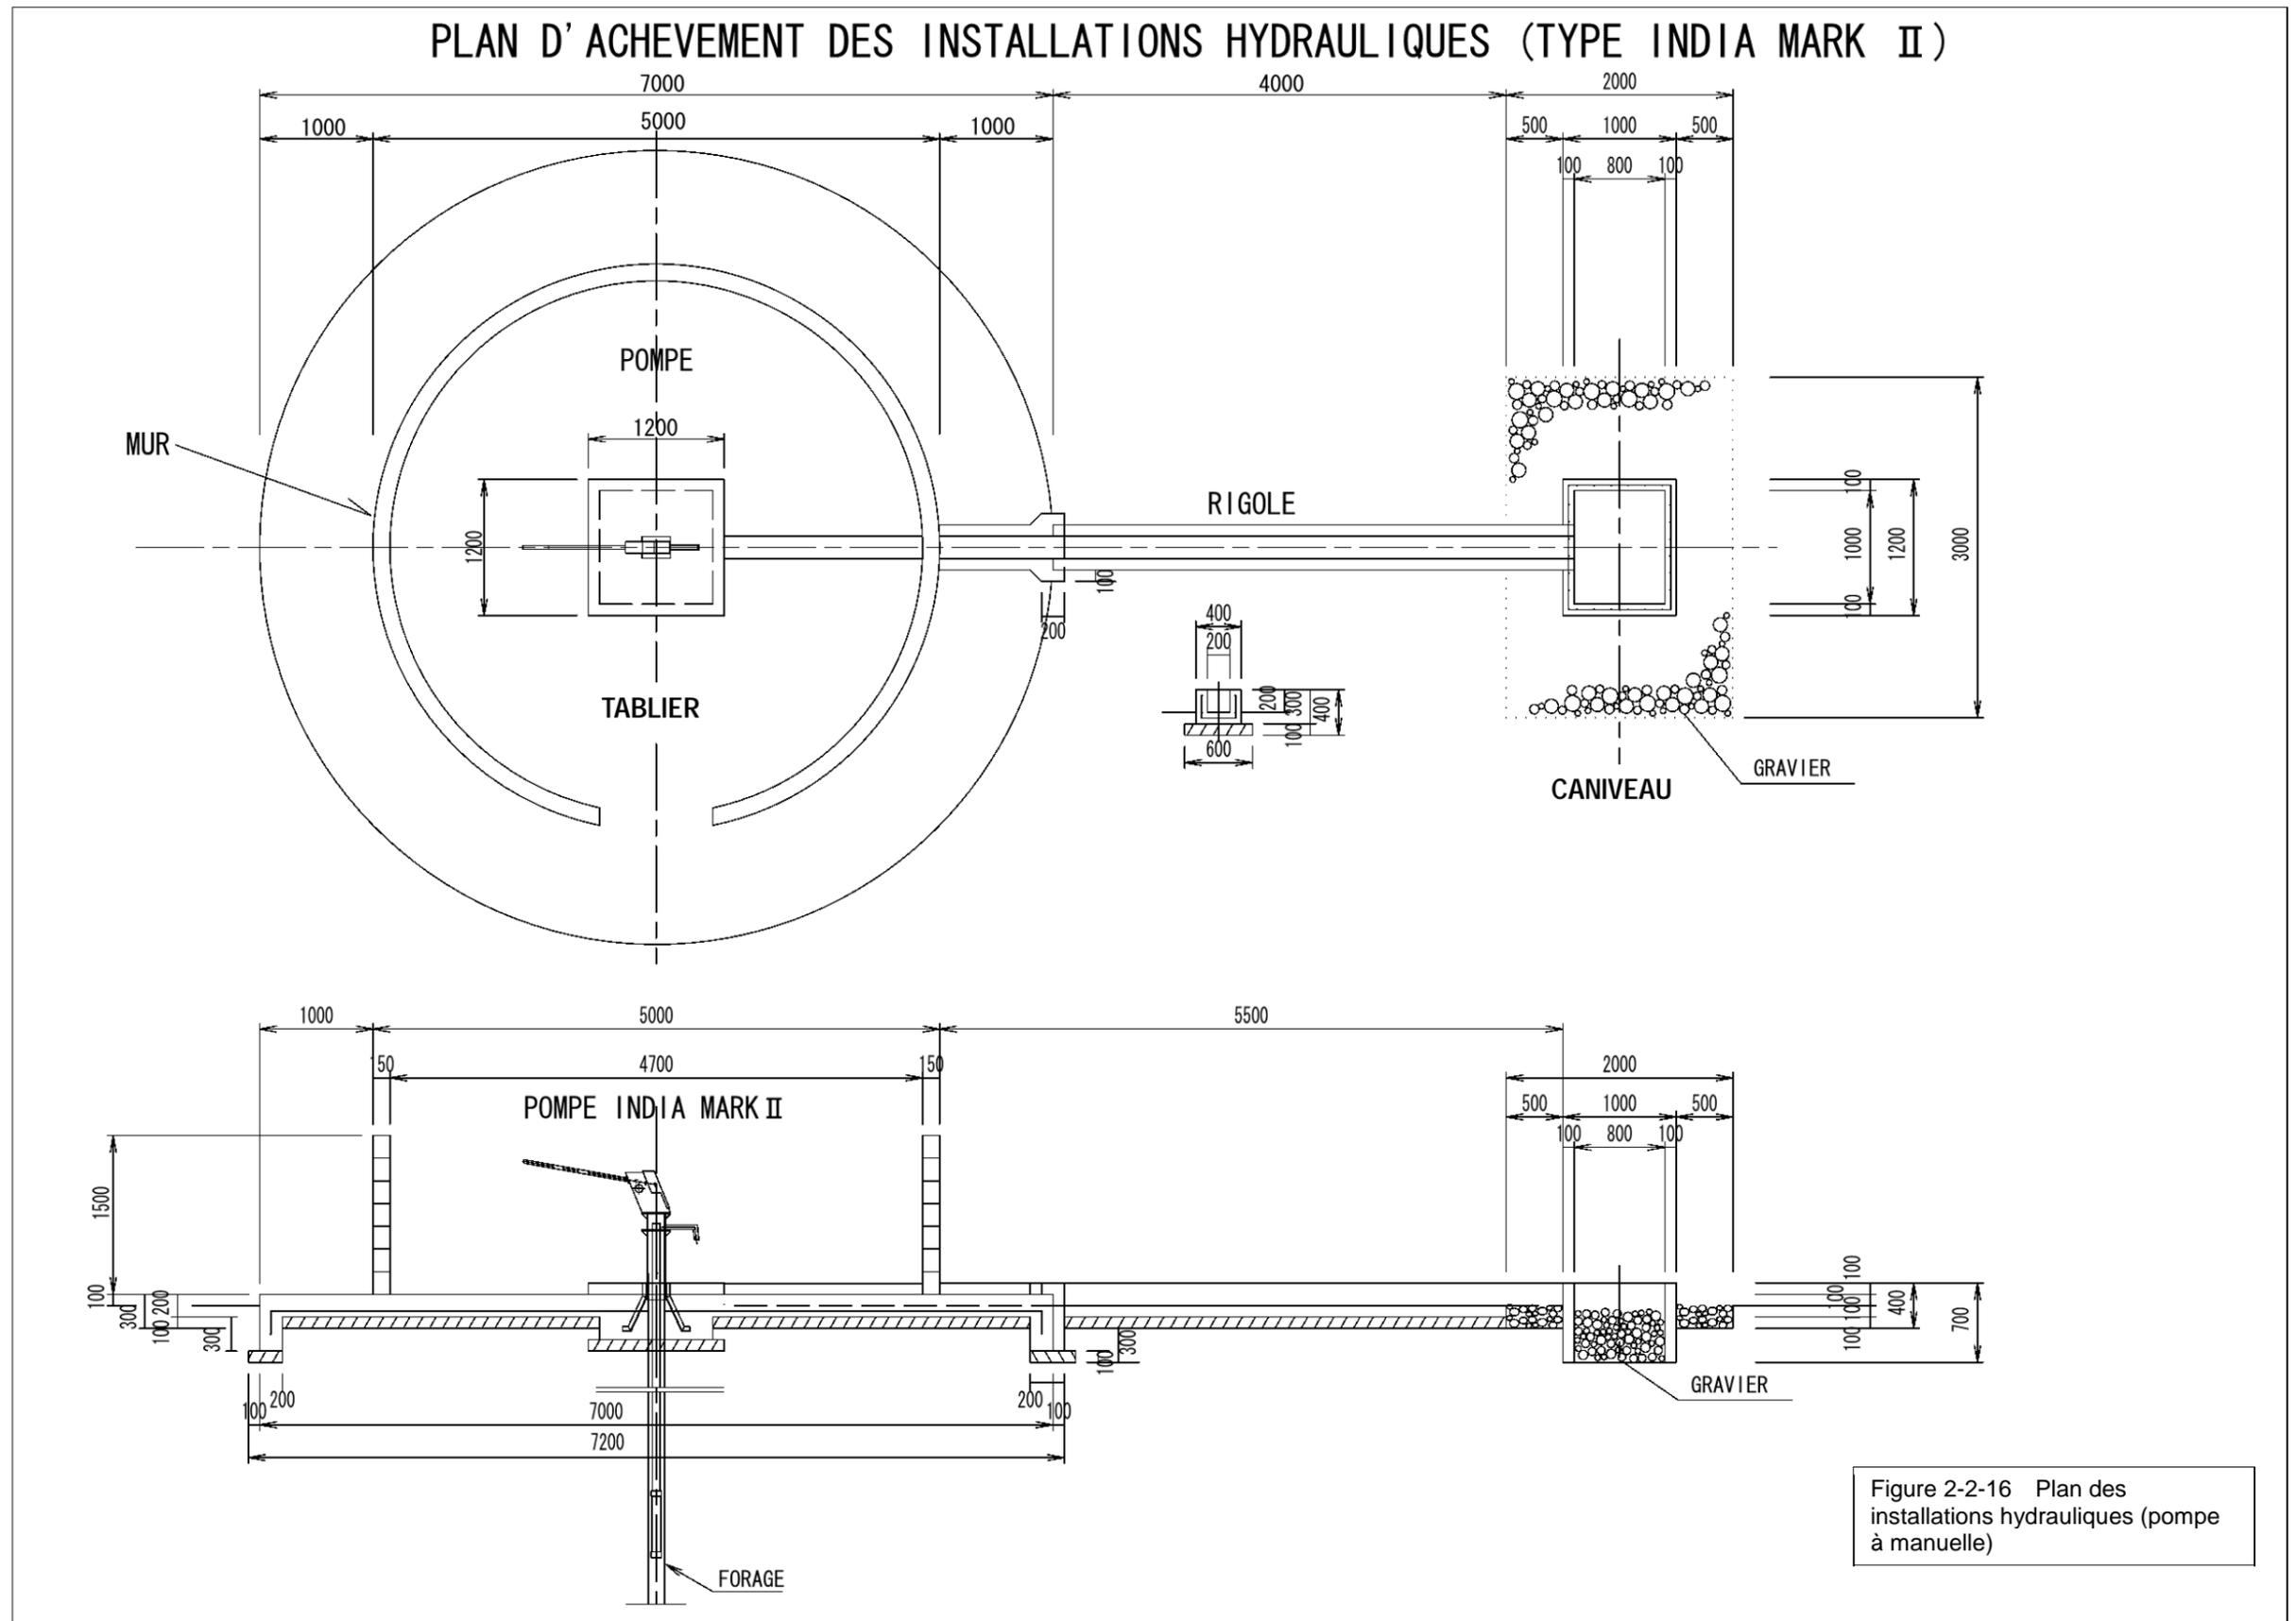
Plan des installations hydrauliques (pompe à manuelle)
